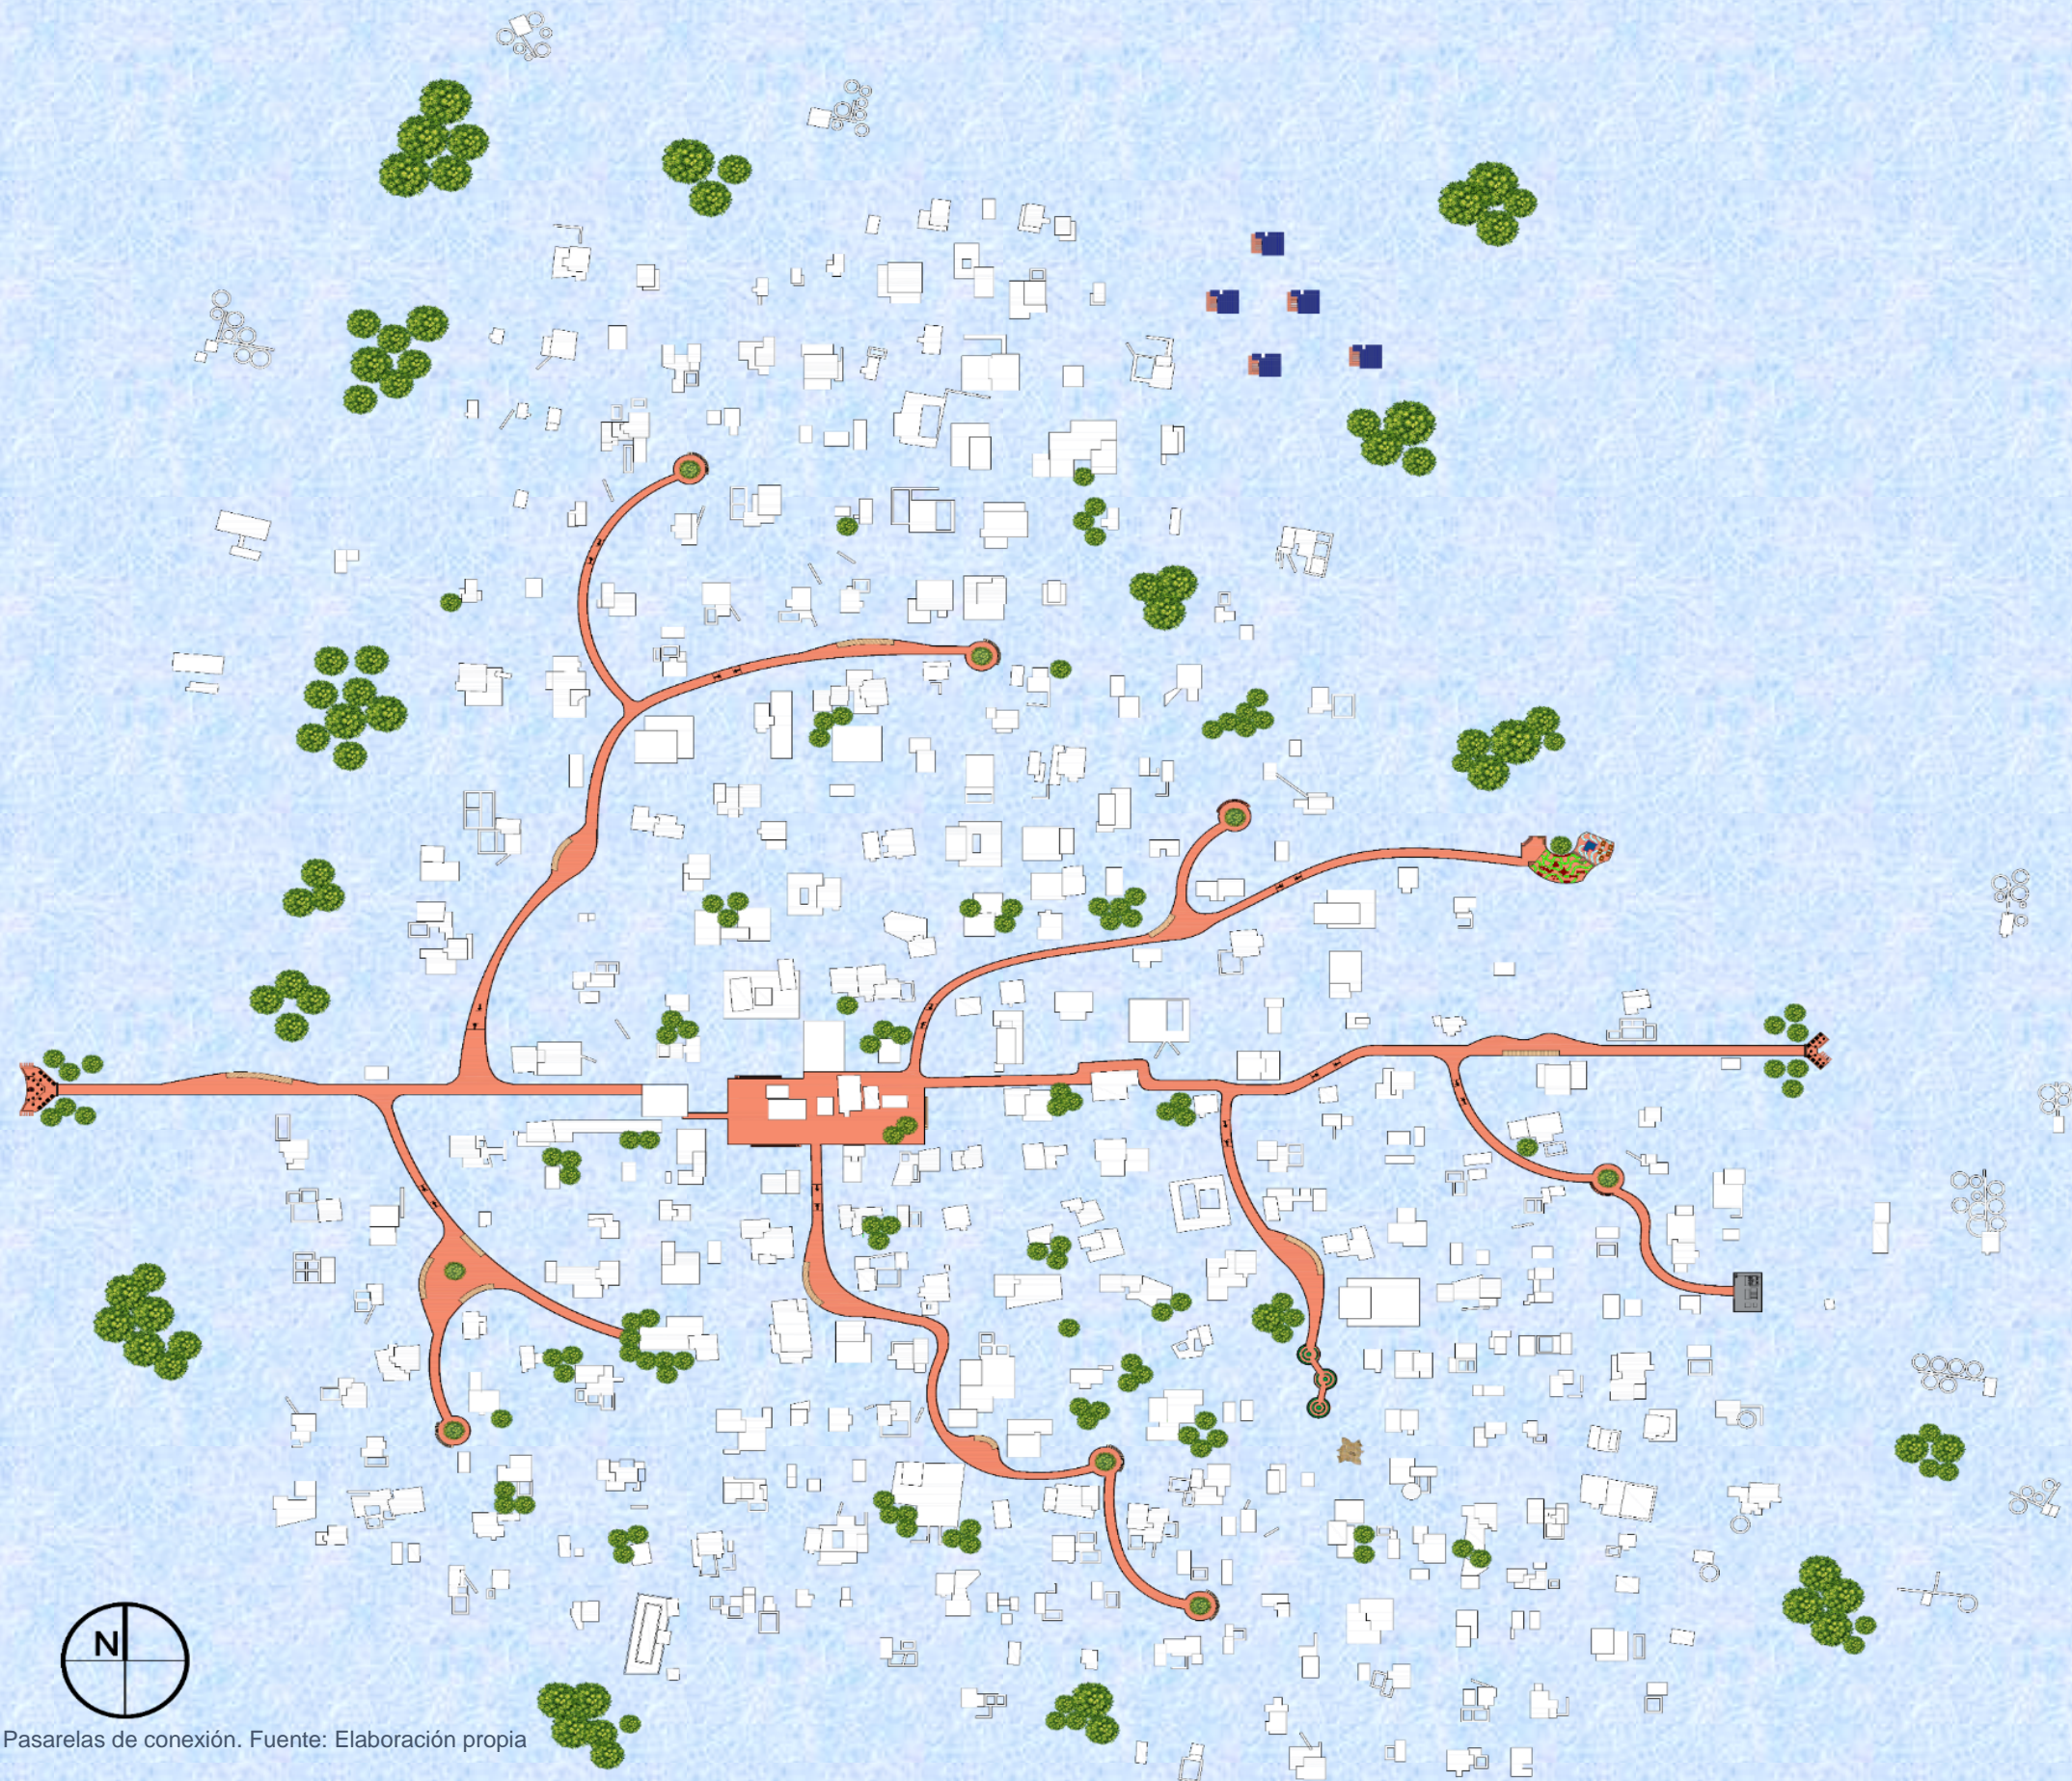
Planta general Pasarelas de conexión. Fuente: Elaboración propia
